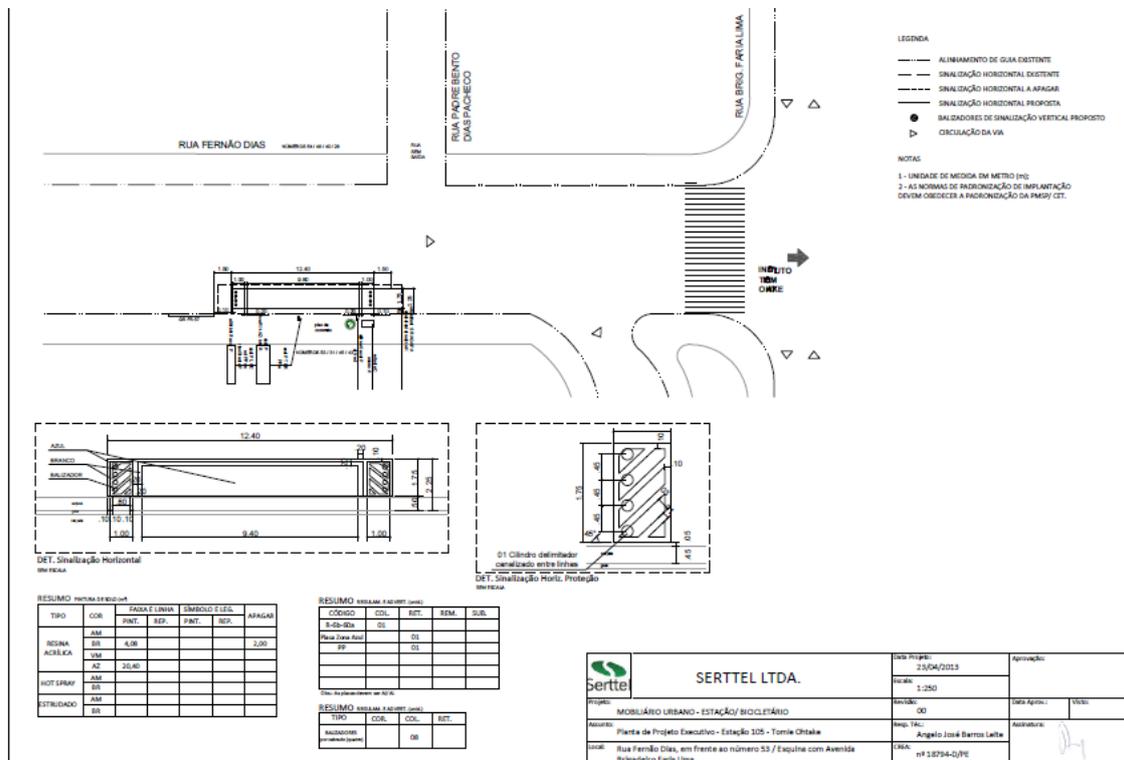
Exemplo de planta tipo projeto executivo com sinalização horizontal e vertical considerando a área do entorno do equipamento a ser instalado.
